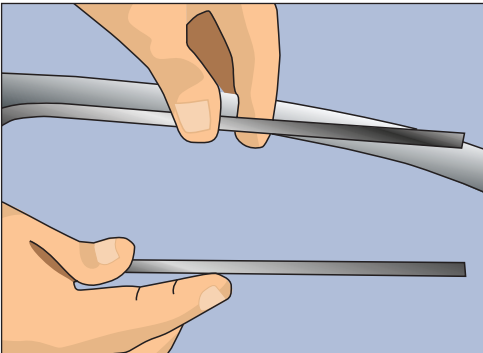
Внутренняя оправка для гибки металлопластиковых труб
